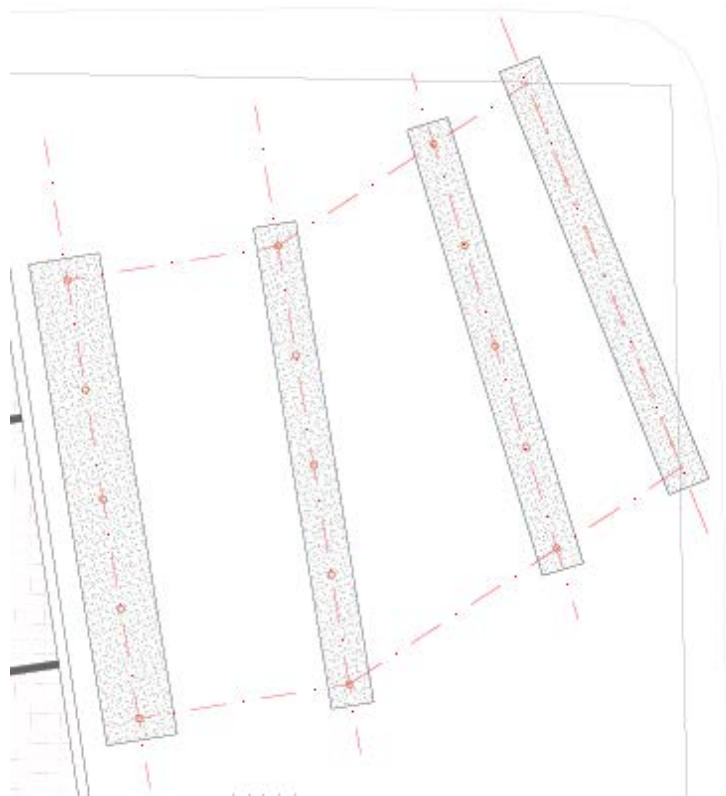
Cimentación directa de la cubierta de la caseta del aparcamiento. Zapatas.
